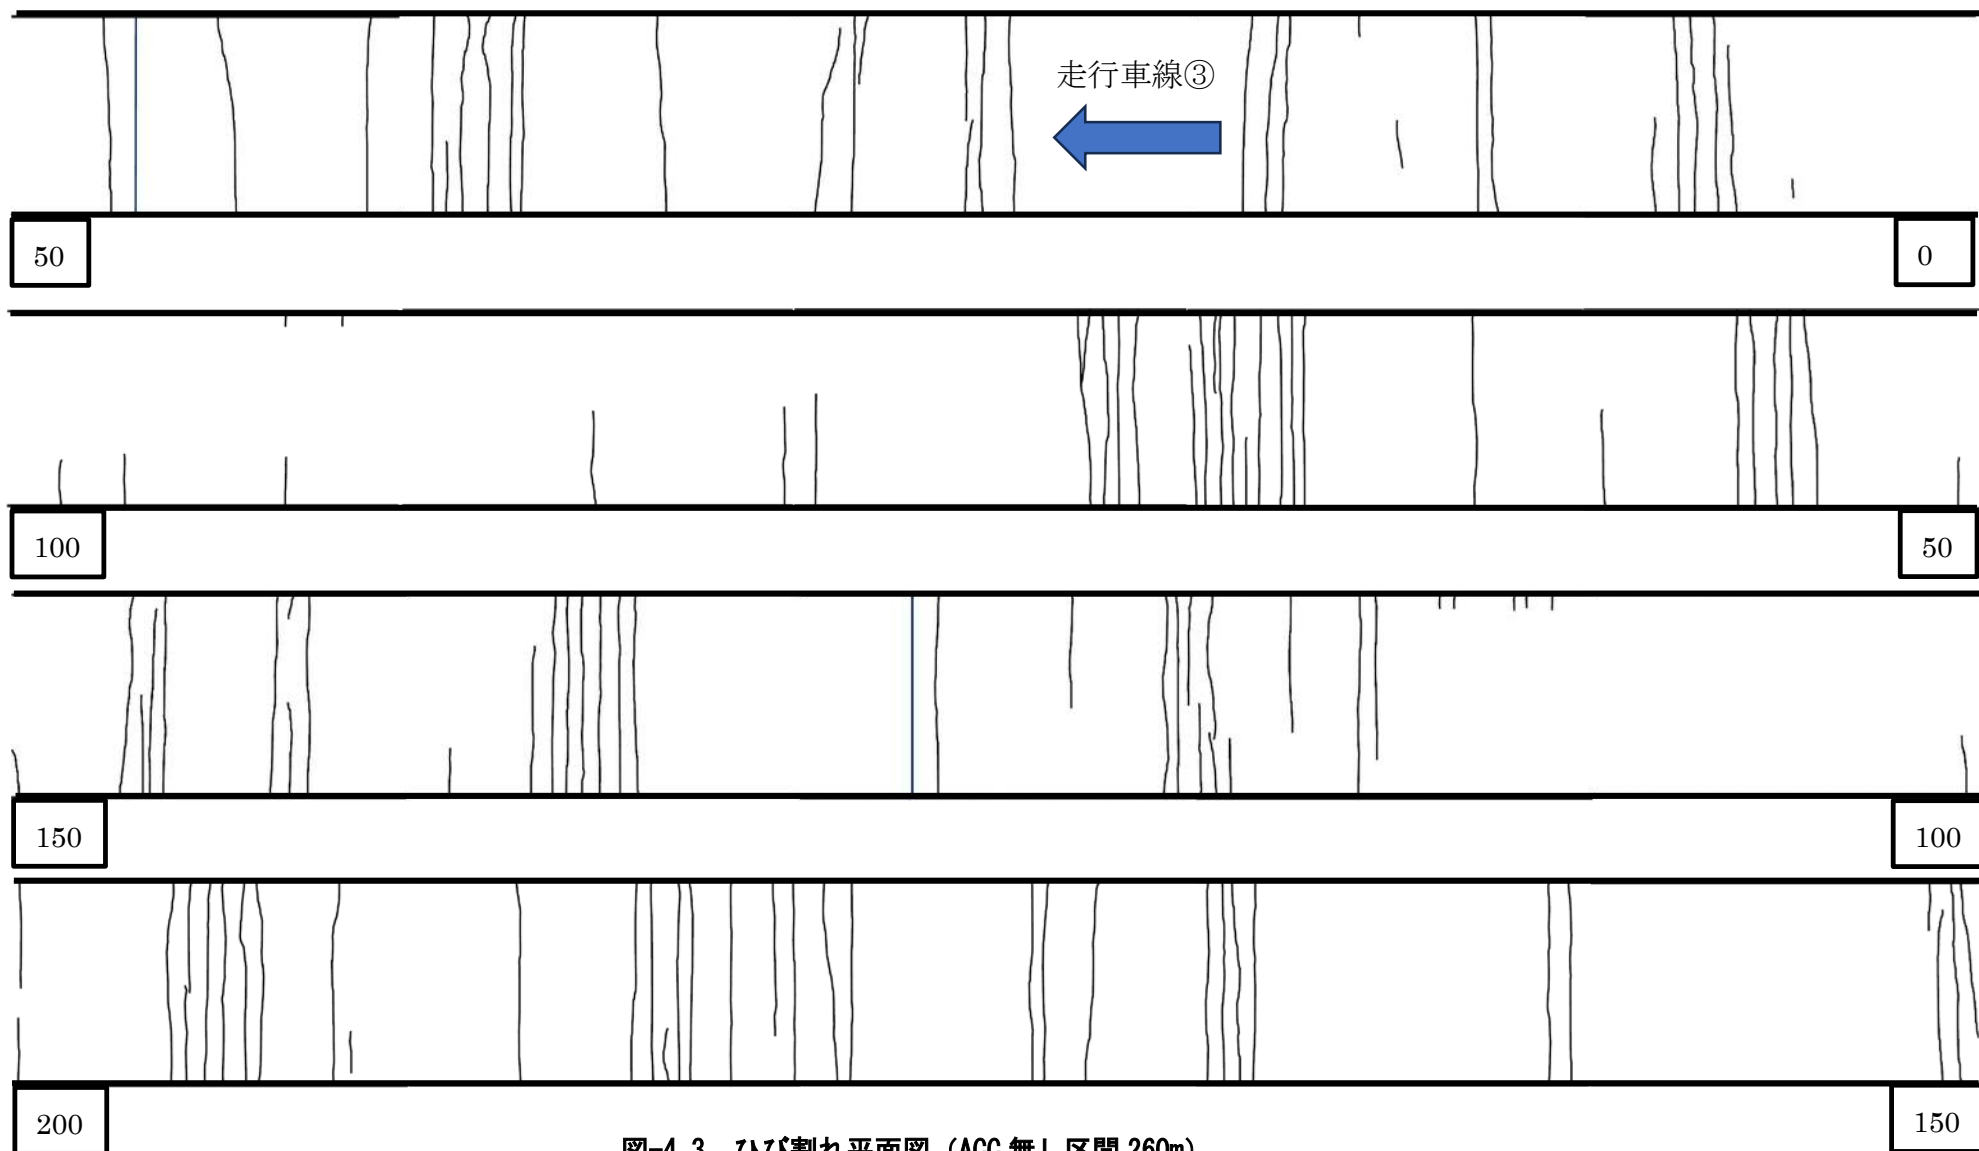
ひび割れ平面図 (ACC 無し区間 260m)
